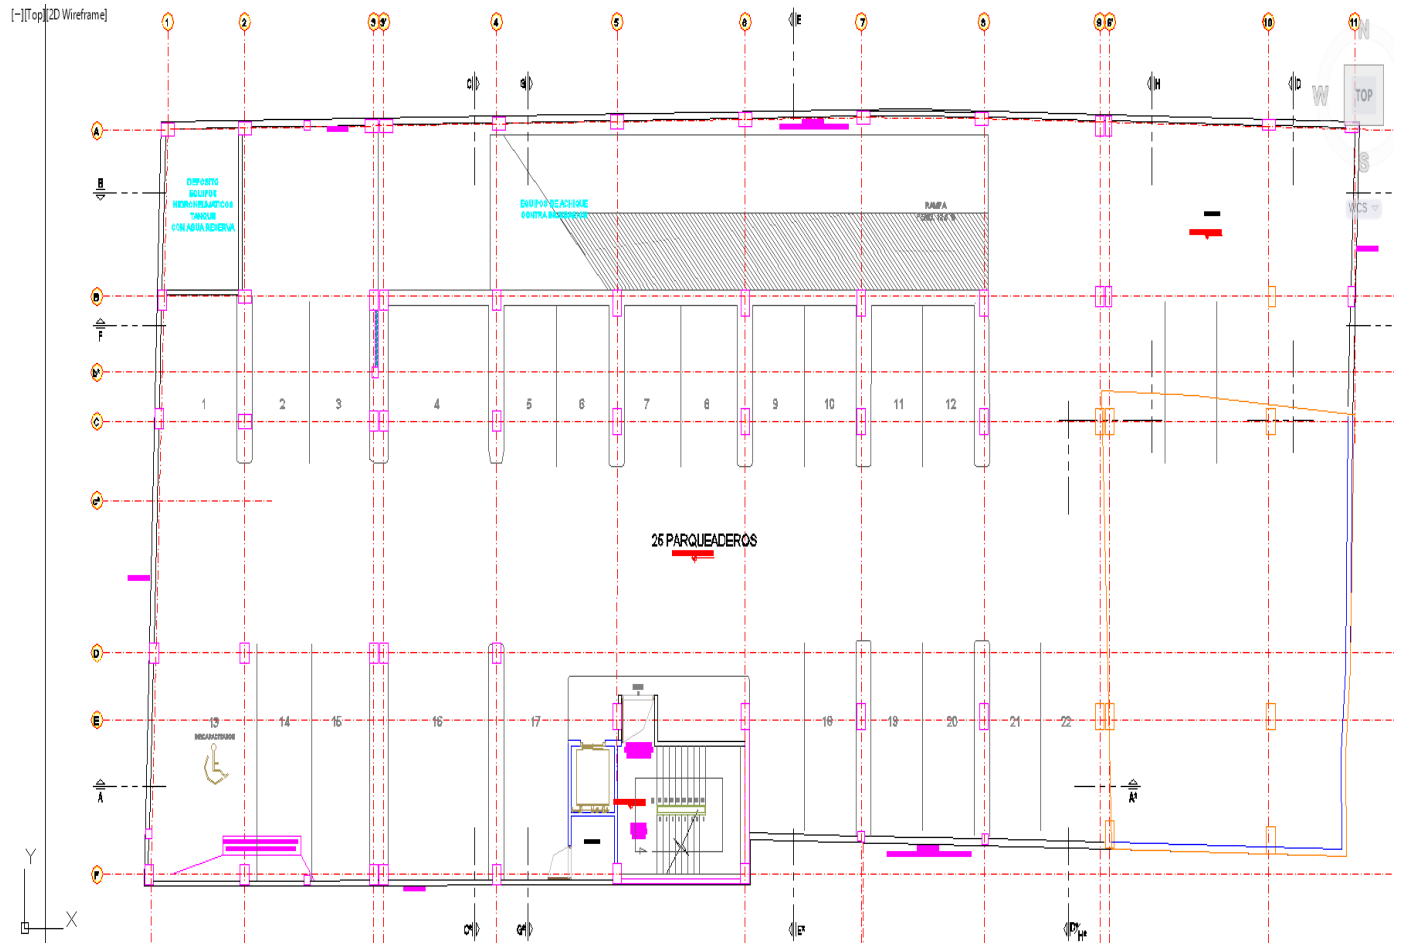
Plano de planta de sótano Nivel -4.81m.
